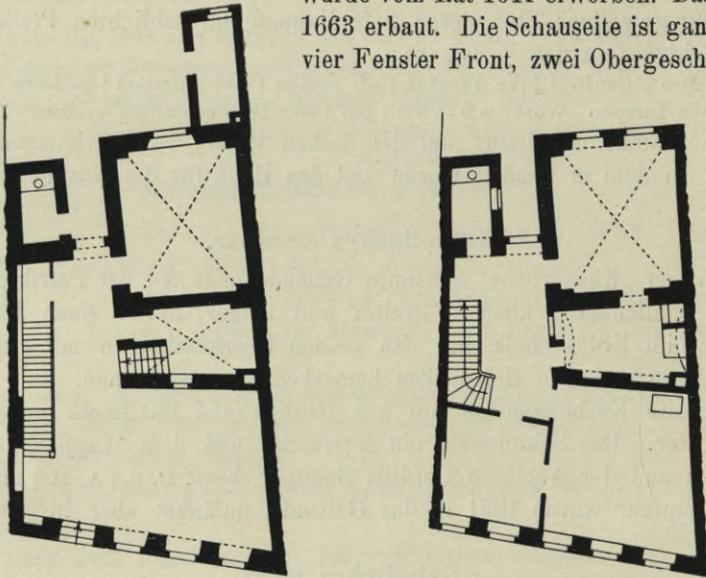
und 190. Sekundariat, Grundriß vom Erdgeschoß und I Obergeschoß.
